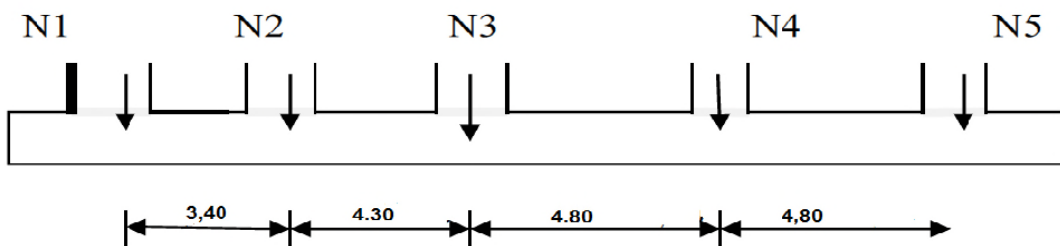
dimensions de la semelle filante(SF4) à ELS
